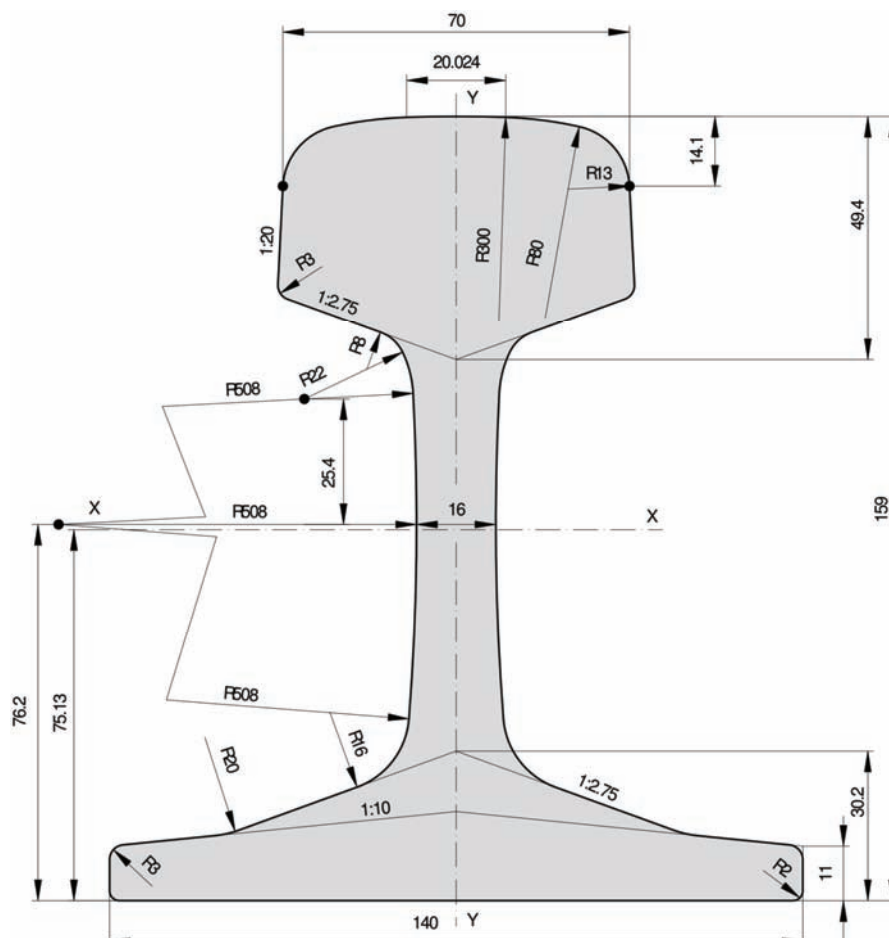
Przekrój poprzeczny szyny 49E1 [18]
